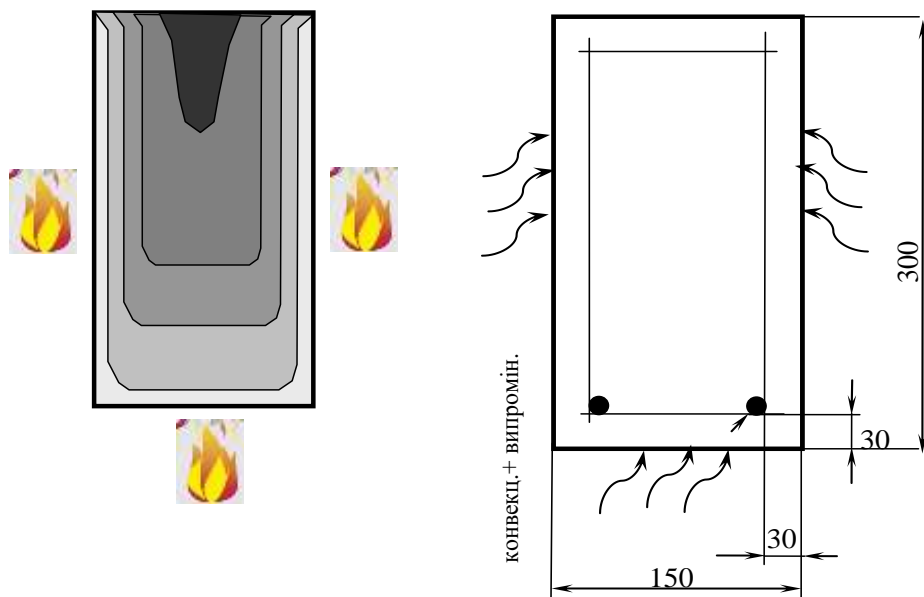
Розрахункова схема до теплового розрахунку залізобетонної балки
